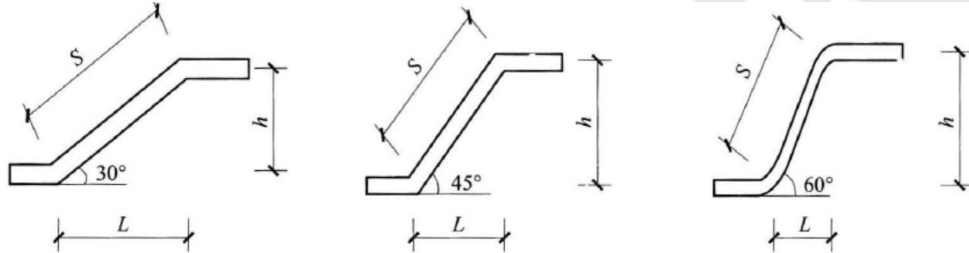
弯起钢筋增加长度示意图 (S-L)
